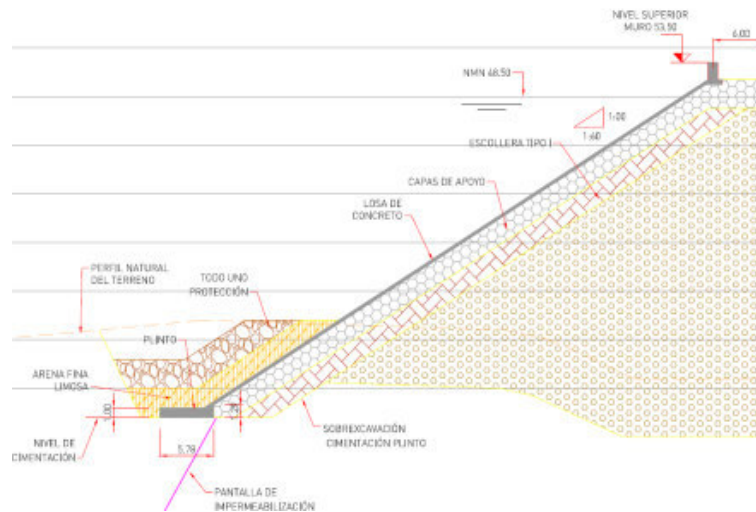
18 Estructura plinto cauce presa PAACUME
